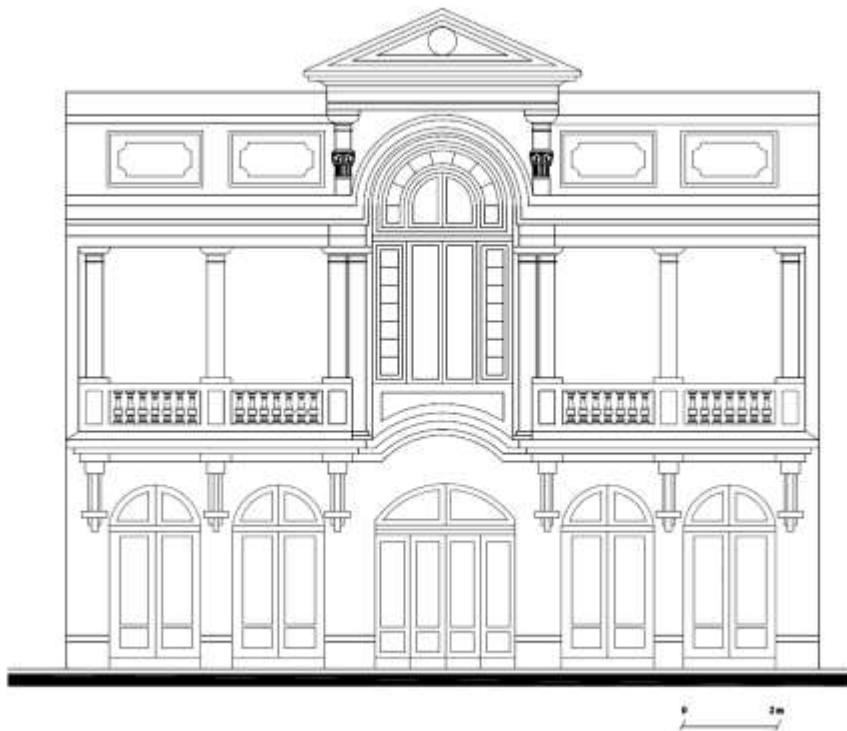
Façade principale de la salle, elle donne sur l'entrée semi couverte.
